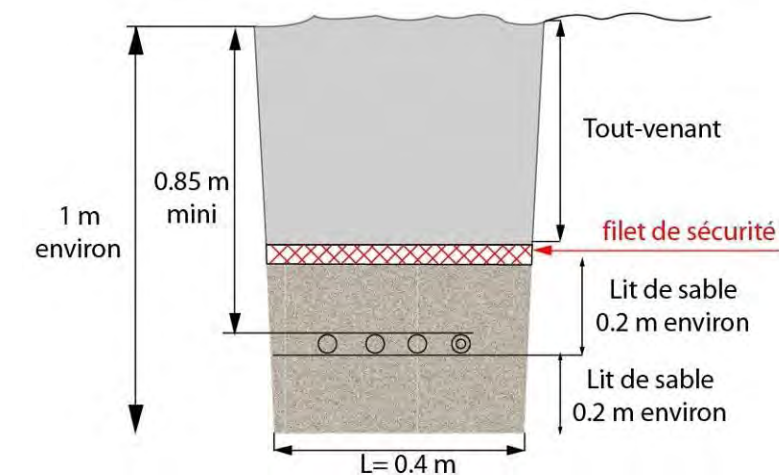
Coupe de tranchée pour enfouissement de ligne
